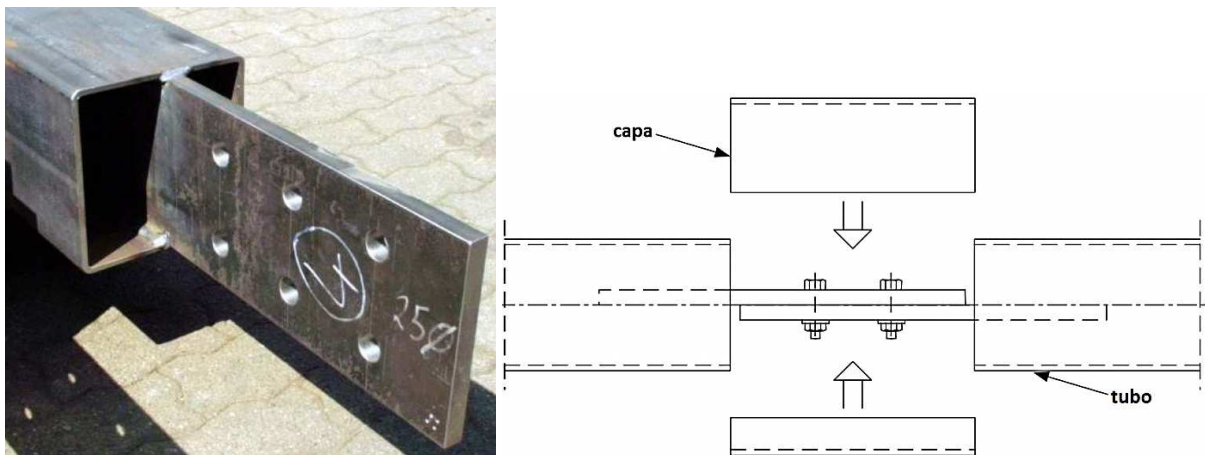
Chapa dentro do tubo. a): aplicação real; b): vista lateral (Fonte: Willibald, 2003)
